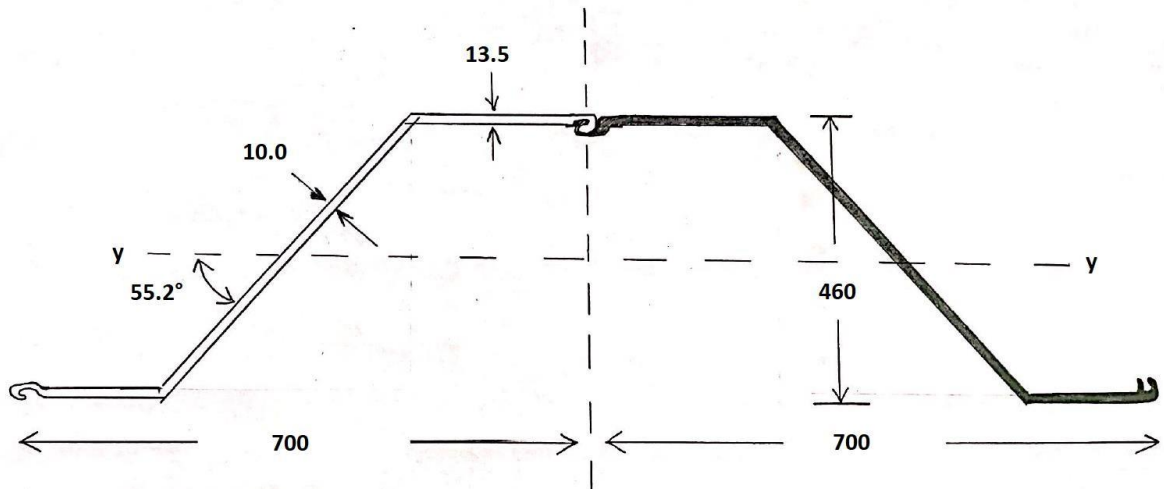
Perfil transversal tablestacas AZ 26-700, unidades en (mm). Fuente: Elaboración propia.
